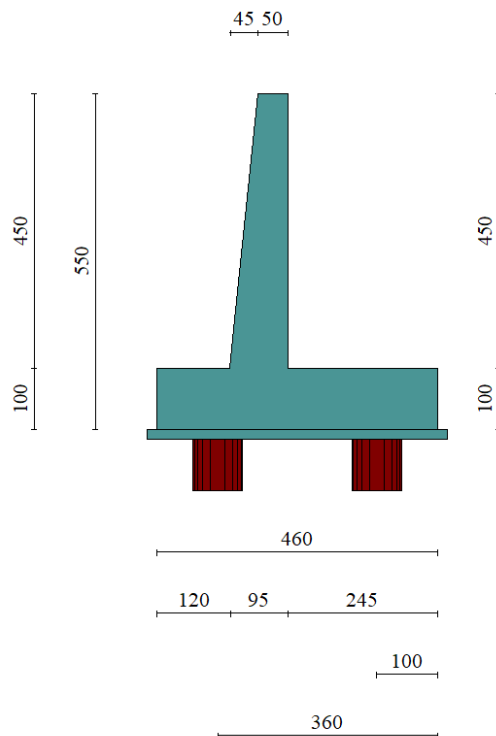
Geometria dei MURI DI CONTRORIPA - FONDAZIONE SU PALI - TIPO 2
